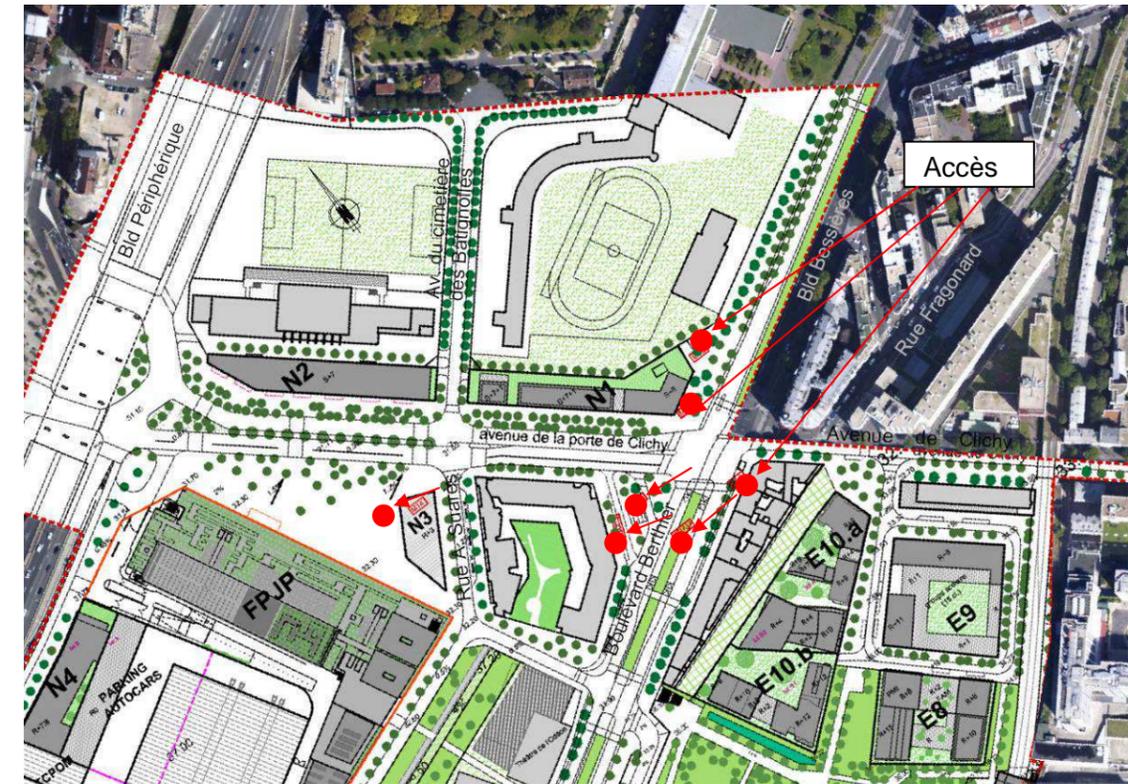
Plan de situation de la station Porte de Clichy (Source : AVP Architecte AZC - IndC)
